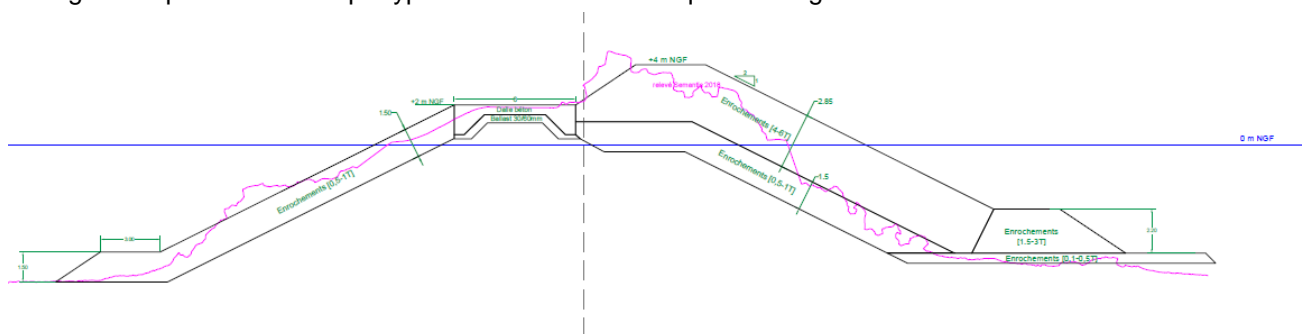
coupe-type du talus pour la digue de protection du plan d'eau
